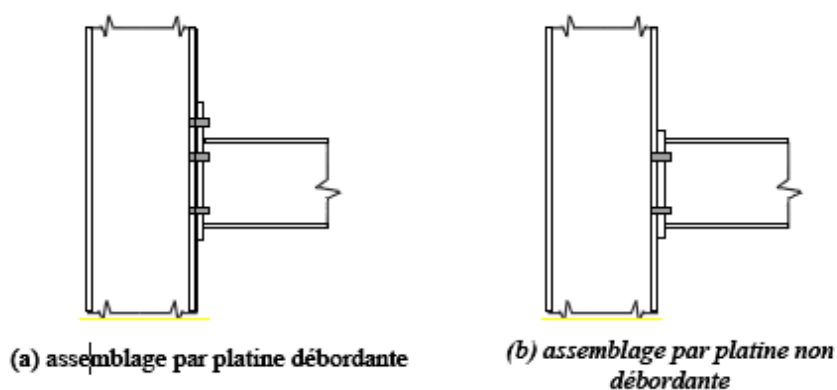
Assemblage poteau poutre par platine d'about boulonnée.
